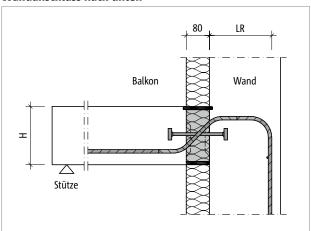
Schöck Isokorb® T Typ QP-WU: Wandanschluss nach unten bei Außendämmung
